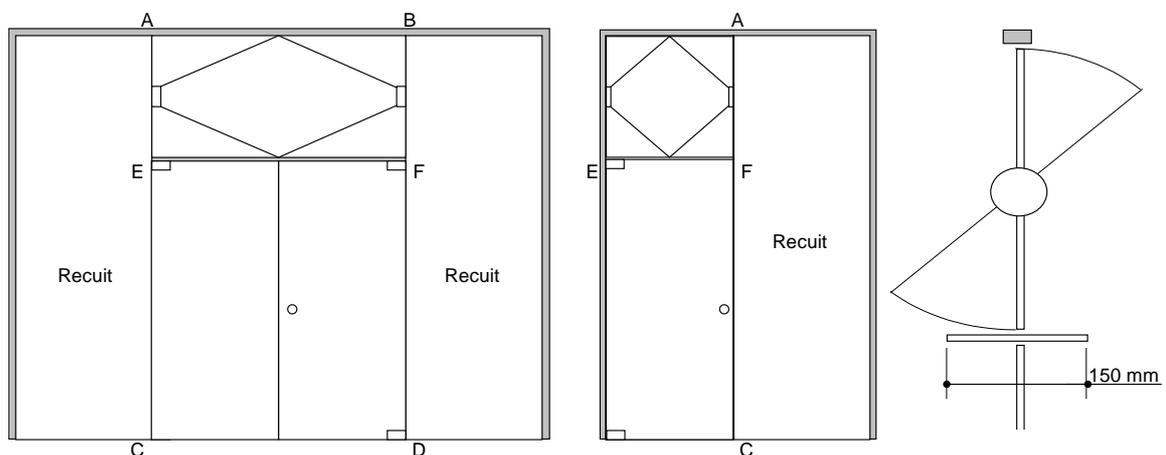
Installations mixtes avec imposte basculante, Cas V
